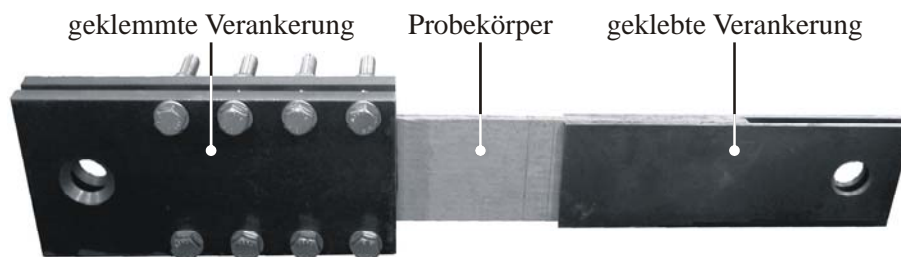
Probekörper mit Lasteinleitungsklemmböcken und -klebelaschen
